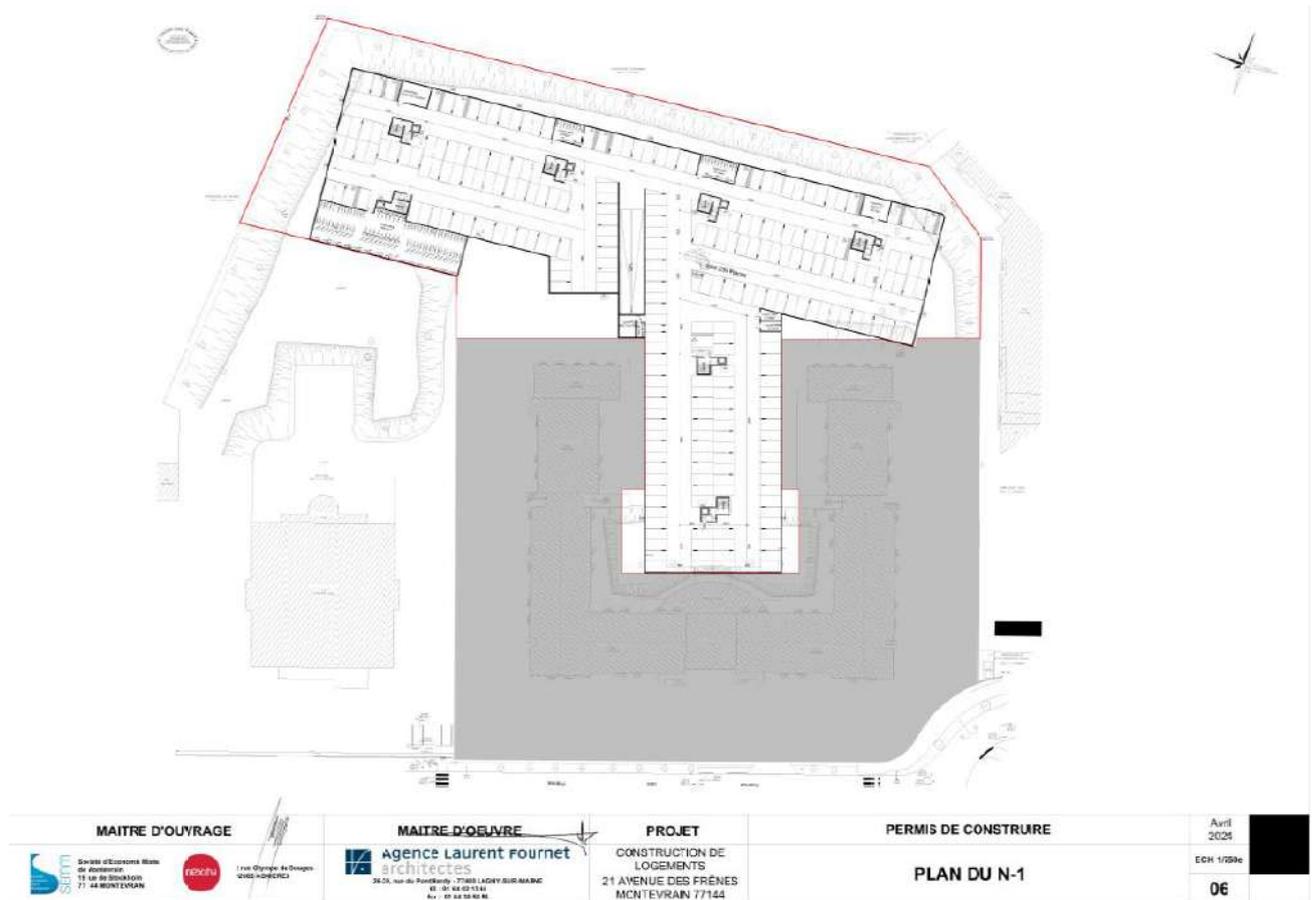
Places de stationnement en sous-sol (source : Dossier PC, plan N-1, Nexity - avril 2024)
